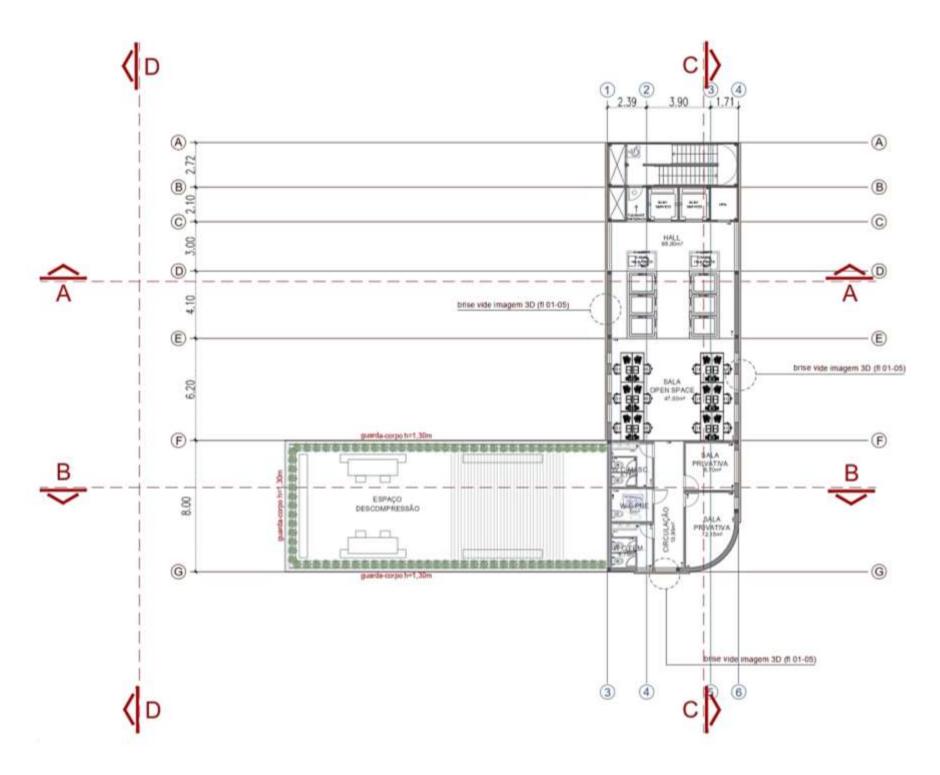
Planta Tipo do7° ao 10° Pavimentos
